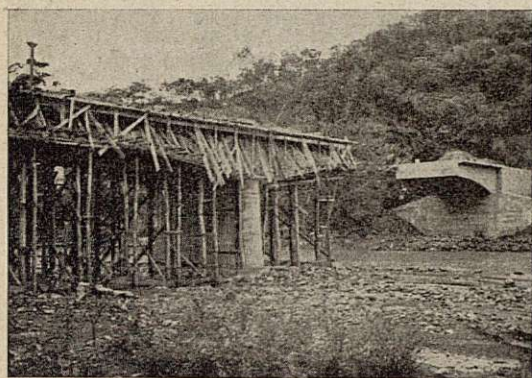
Ménsula del lado de Bogotá terminada, y tramo de 23 metros y ménsula del lado de Girardot, sobre la cimbra
